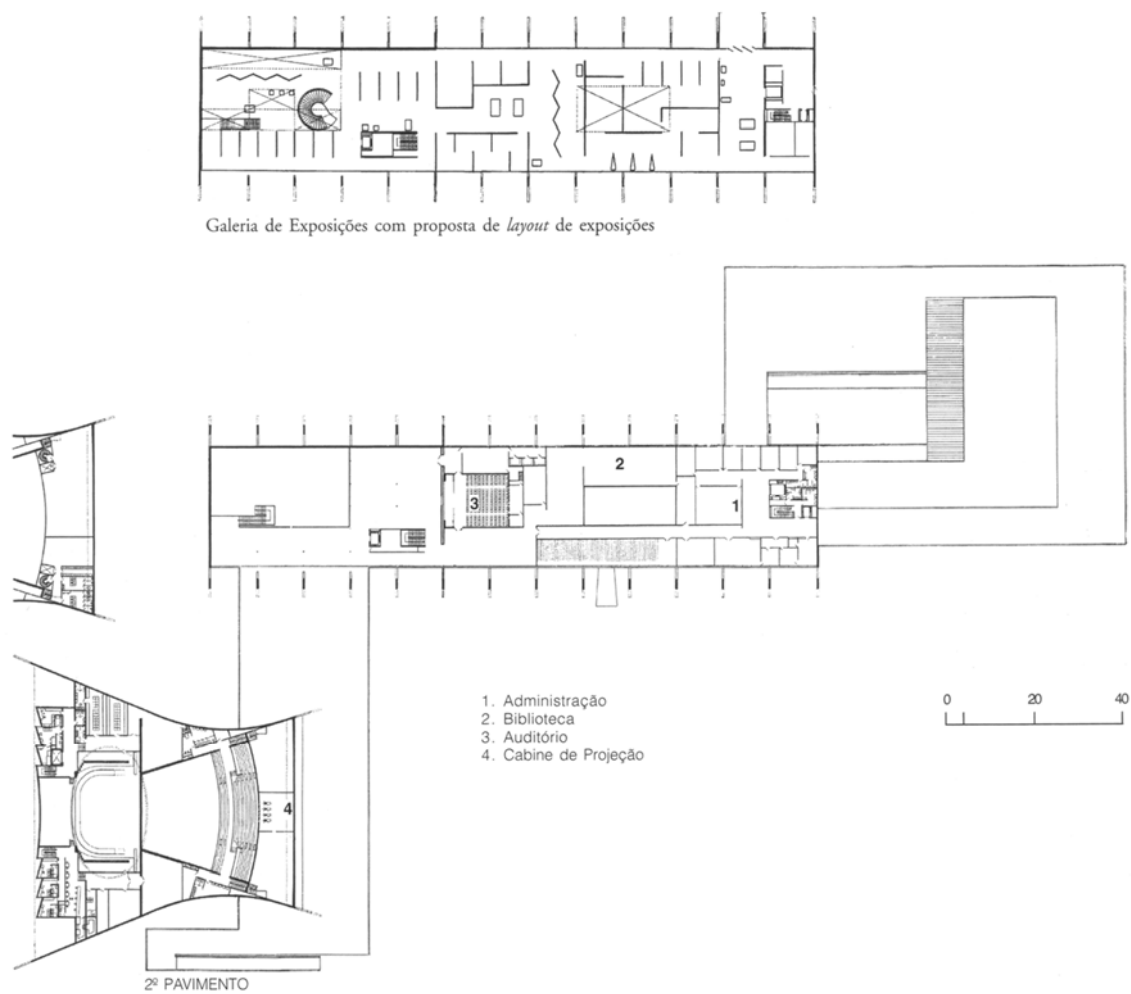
MAM RJ. Planta do 2º pavimento.
